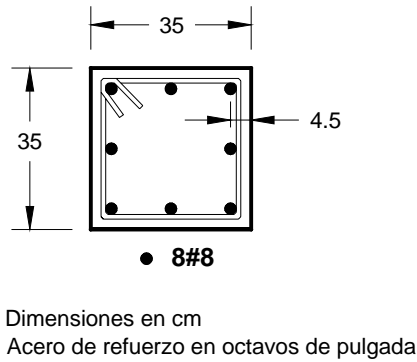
Configuración del armado de las columnas U1, U4 (Saatcioglu y Ozcebe, 1989)
